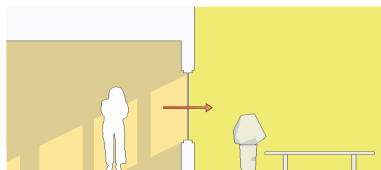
Acristalamiento fachada norte. Elaboración propia.
